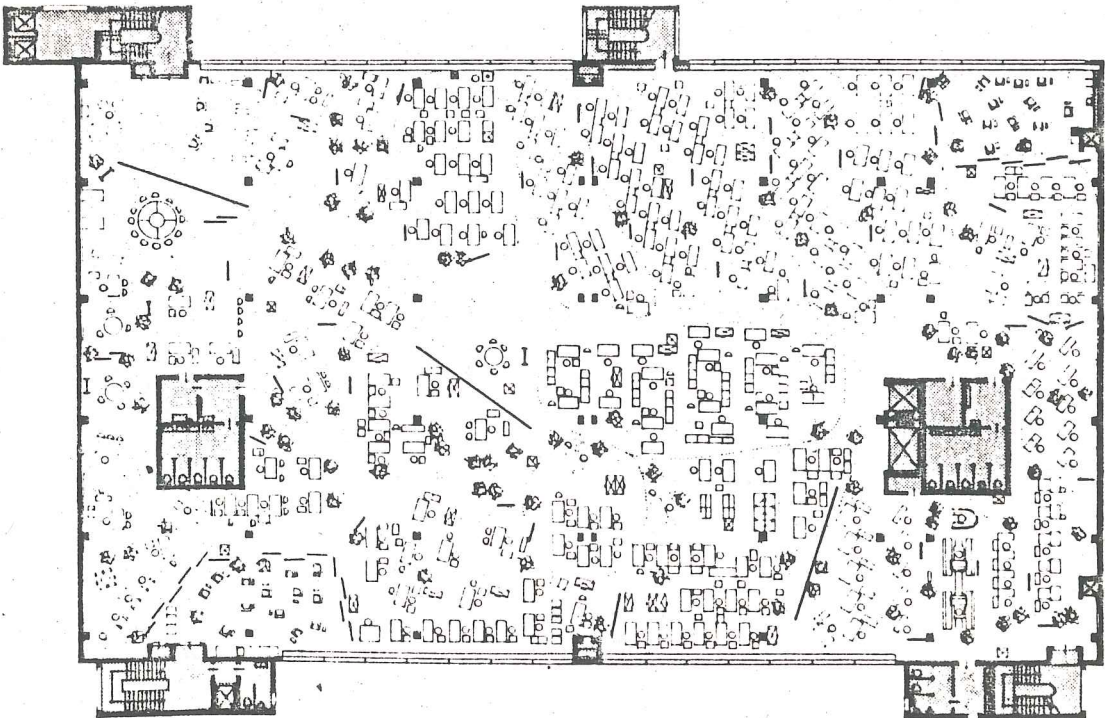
'de Açık planlı büro hacimlerine örnekler verilmiştir.
